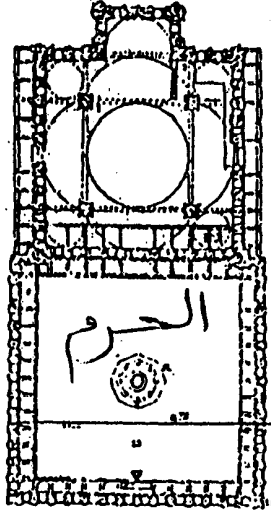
مسقط أفقي لجامع السلطان أحمد الأول باستانیول (عن : Goodwin)
